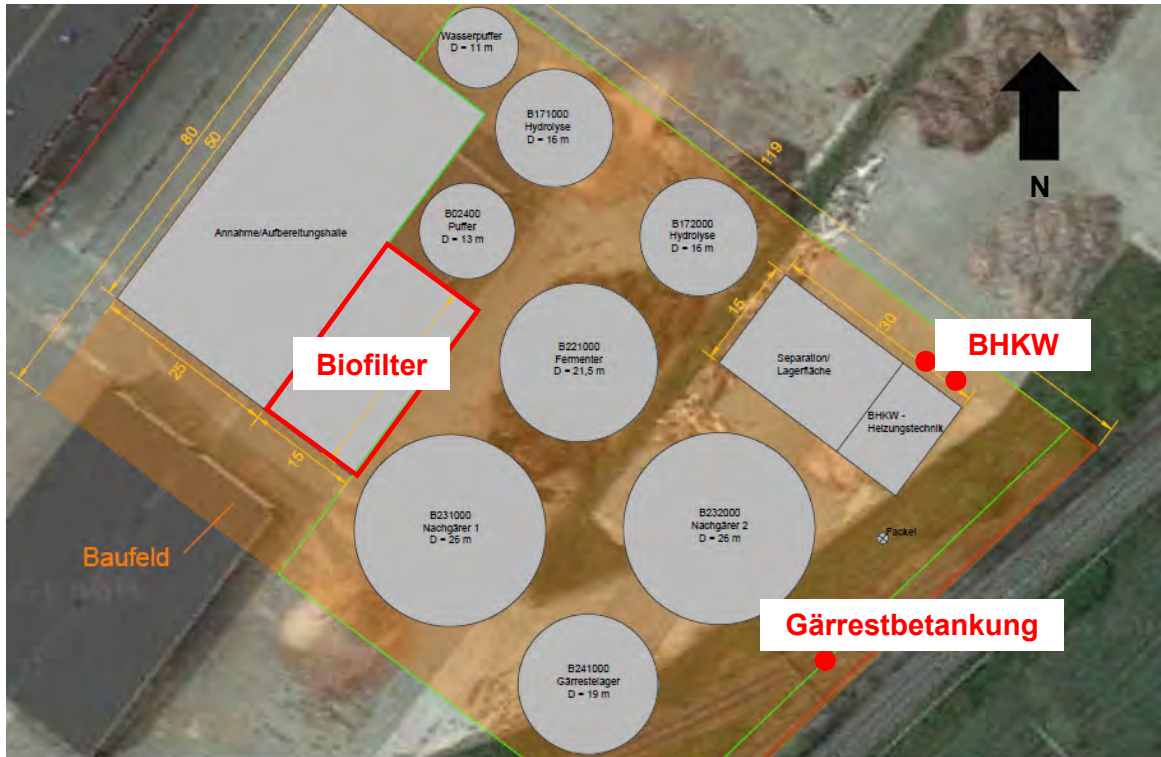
Rührkessel – Beispielhafter Lageplan mit Kennzeichnung der geruchsrelevanten Emissionsquellen (rot)
